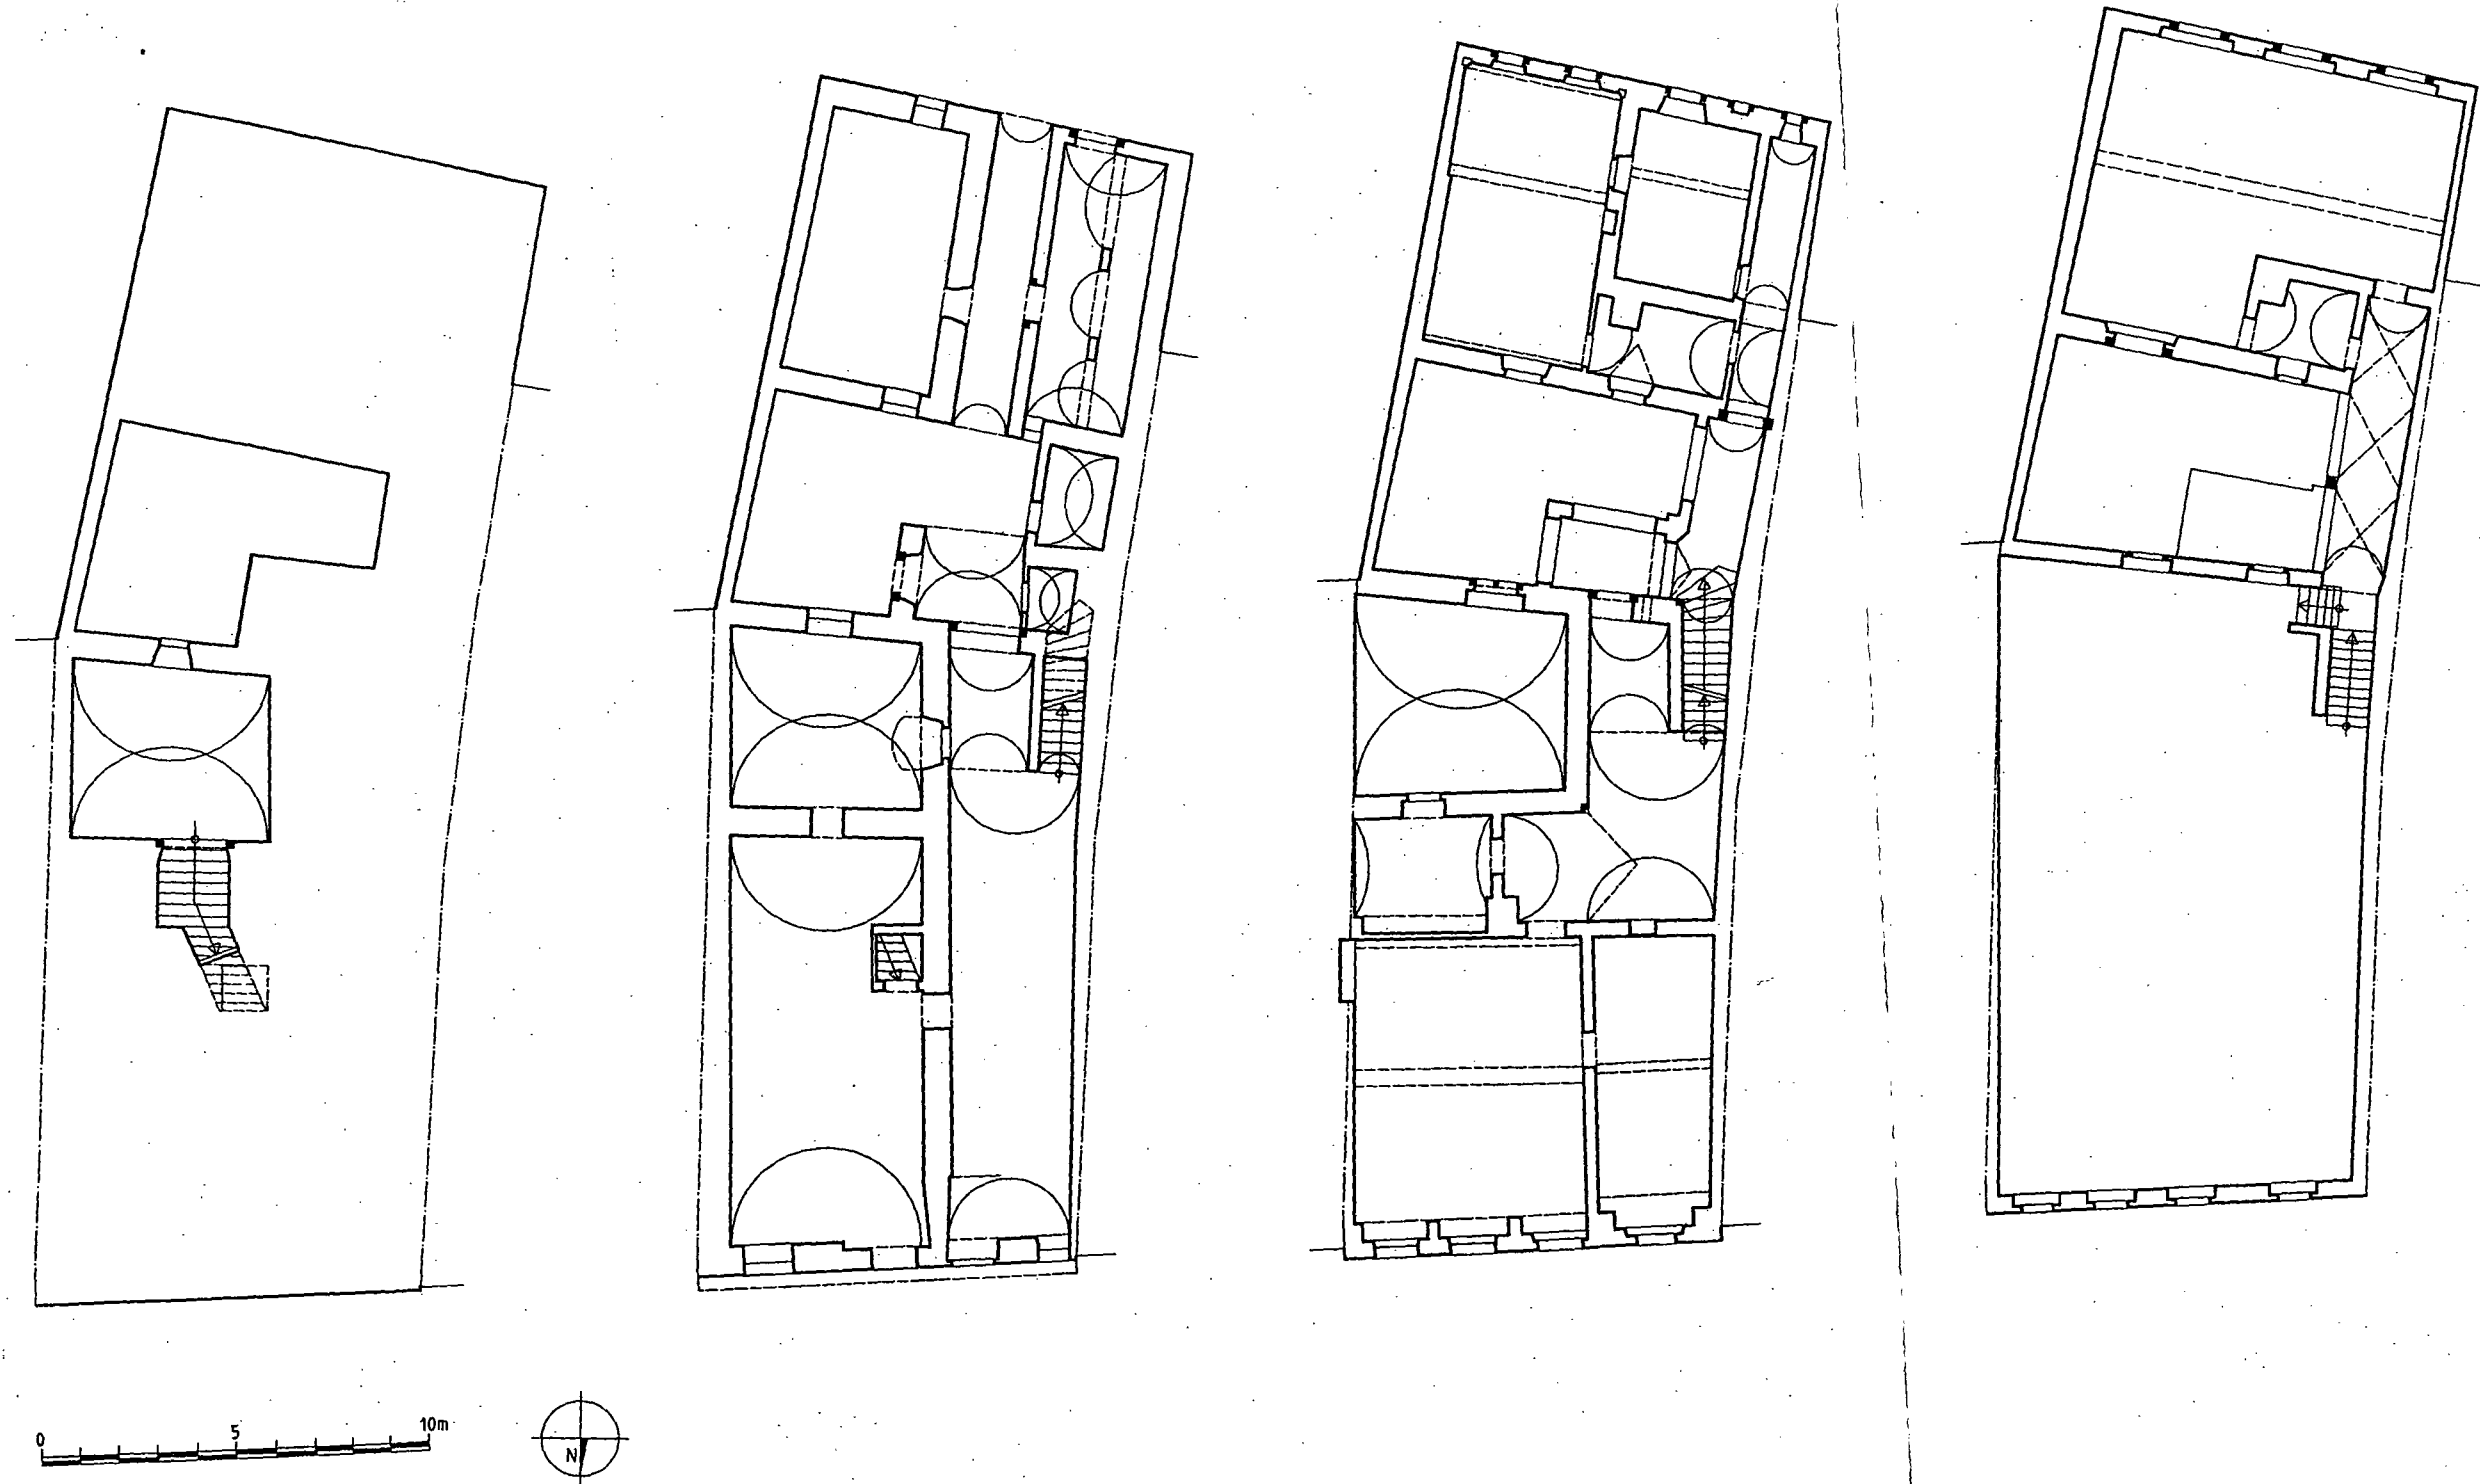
Schmiedstraße 9 – Grundrisse Keller, Erdgeschoss, 1. und 2. Obergeschoss (1:200).
